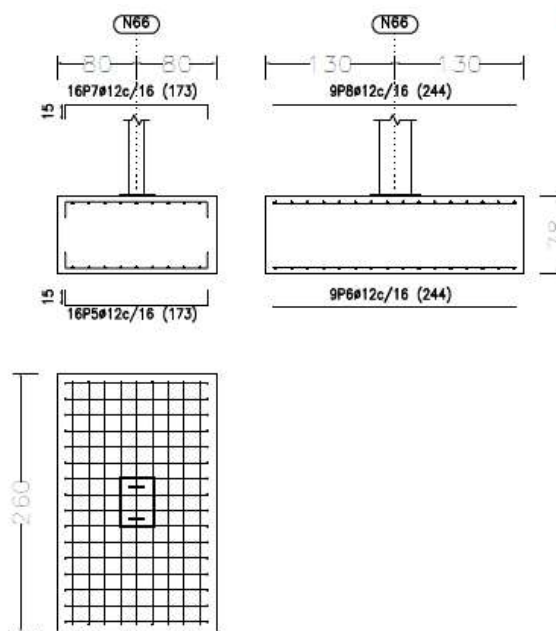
Dimensiones zapata tipo C. (Fuente CYPE 3D).
